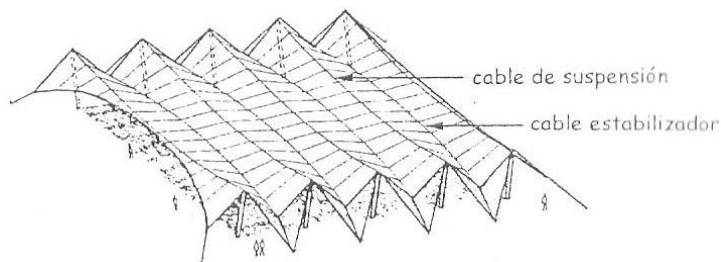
Diagrama de dirección de cargas en estructuras de doble cableado.
